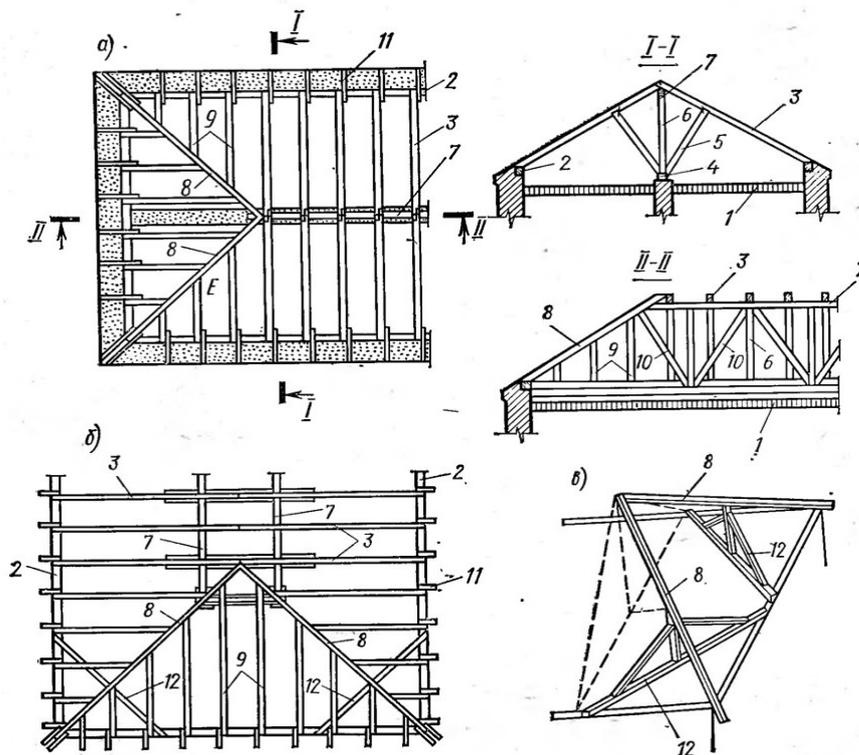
Расположение в плане наслонных стропил в зданиях:
